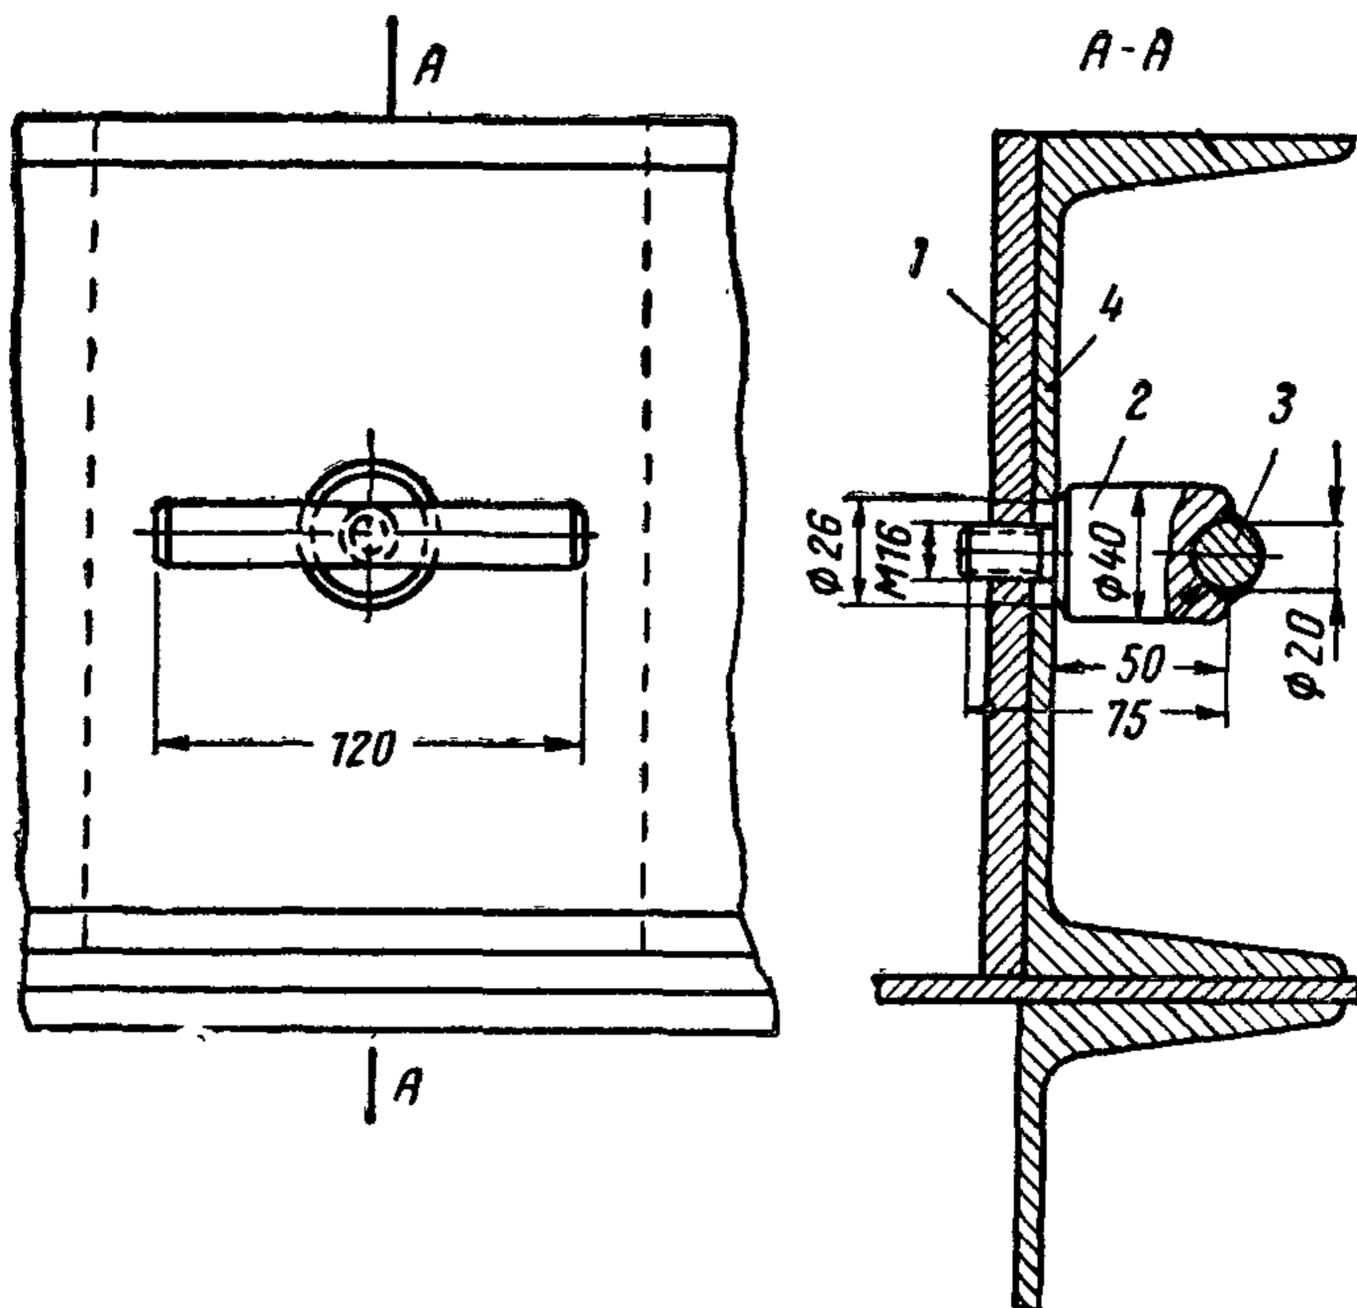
Пример крепления закладной детали к борту формы инвентарным винтовым фиксатором
